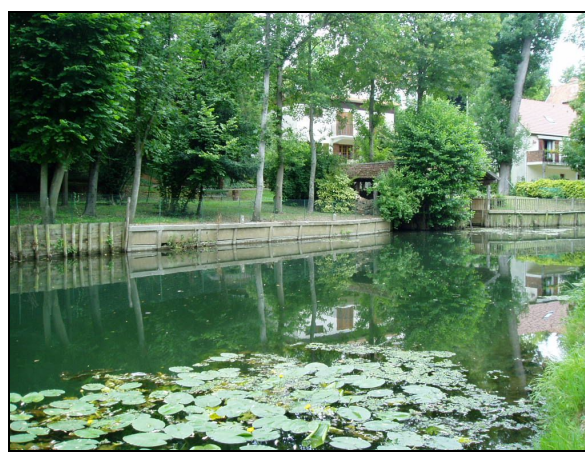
Protection de berge en béton en très mauvais état risquant de s'effondrer (rive droite dans la plaine d'Epinay en aval du barrage de Rochopt)
